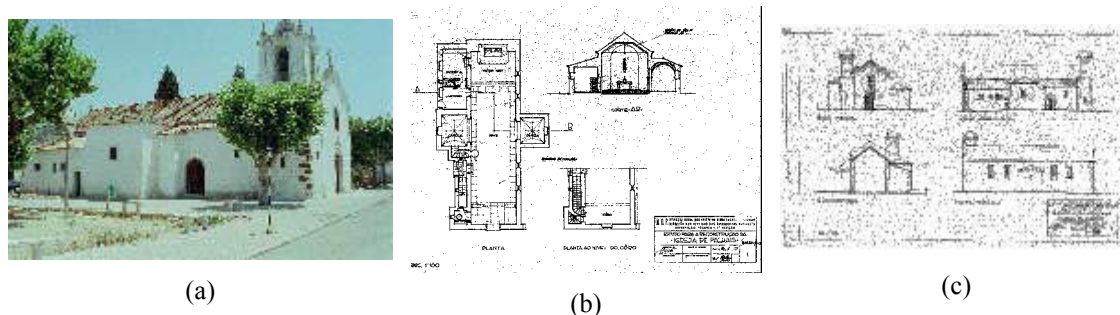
Peças desenhadas [DGEMN].: (a) fotografia; (b) planta e corte transversal; (c) alçados.
